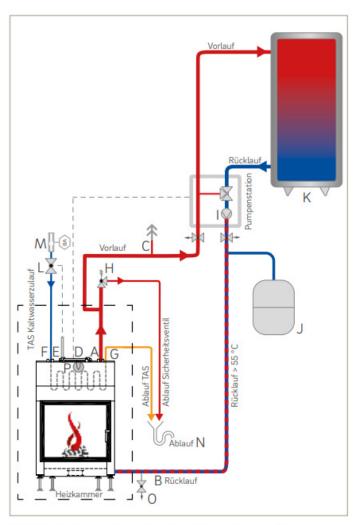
Wassertechnisches Anschlussschema – Prinzipdarstellung
